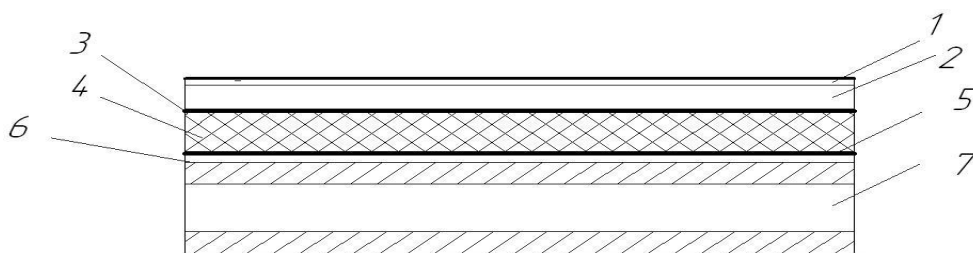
Схема покрівлі: 1 – ізопласт; 2 – стяжка; 3 – гідроізоляція; 4 – утеплювач; 5 – пароізоляція; 6 – вирівнююча стяжка; 7 – плита покриття
